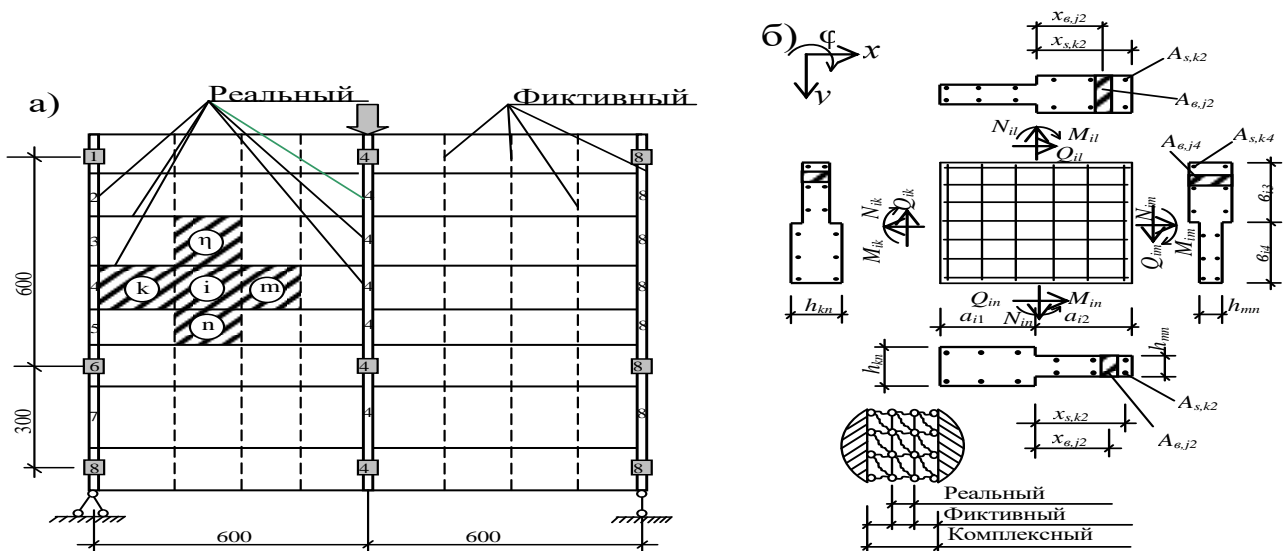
Расчетная схема сборного перекрытия: а) разбивка на элементы; б) Модель МСД для железобетона при плоском напряженном состоянии. реальные диаграммы нелинейного деформирования бетона и арматуры при различных длительностях нагружения, излагаются основные положения их расчетов по указанному методу (рис. 2), подробно развита в работе [1, 2].
